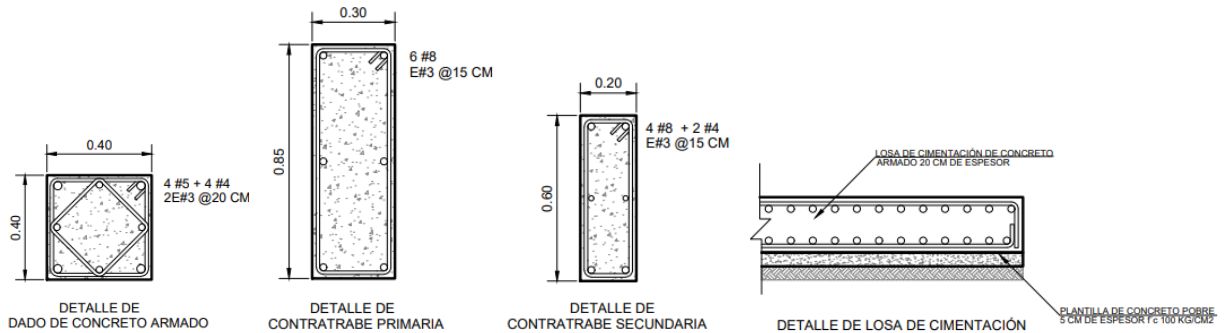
Detalles estructurales; elaboración propia, 2023.
